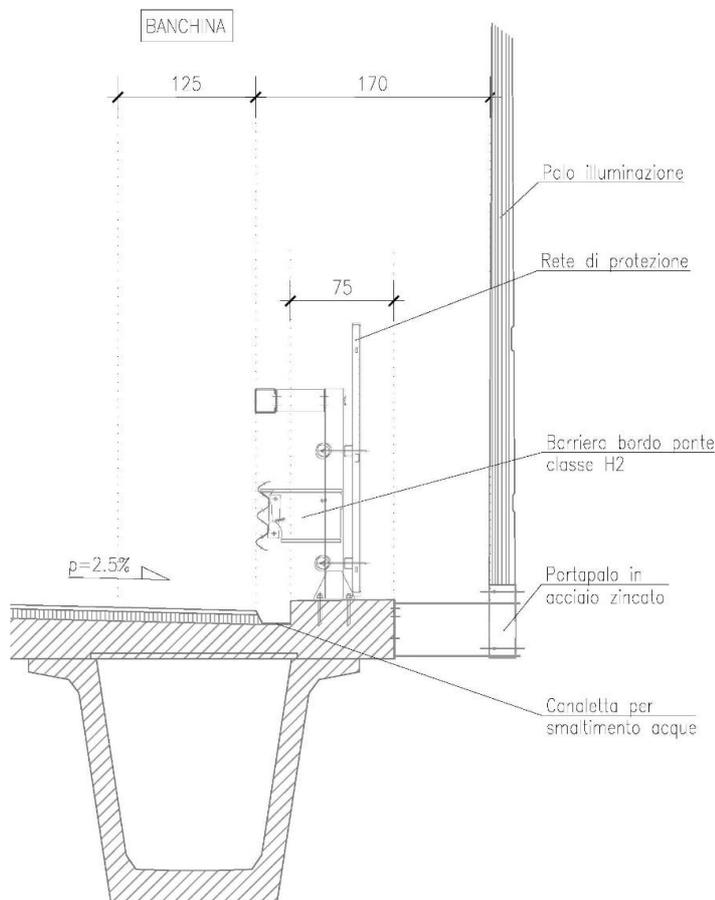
Protezione di progetto viabilità secondaria bordo ponte
